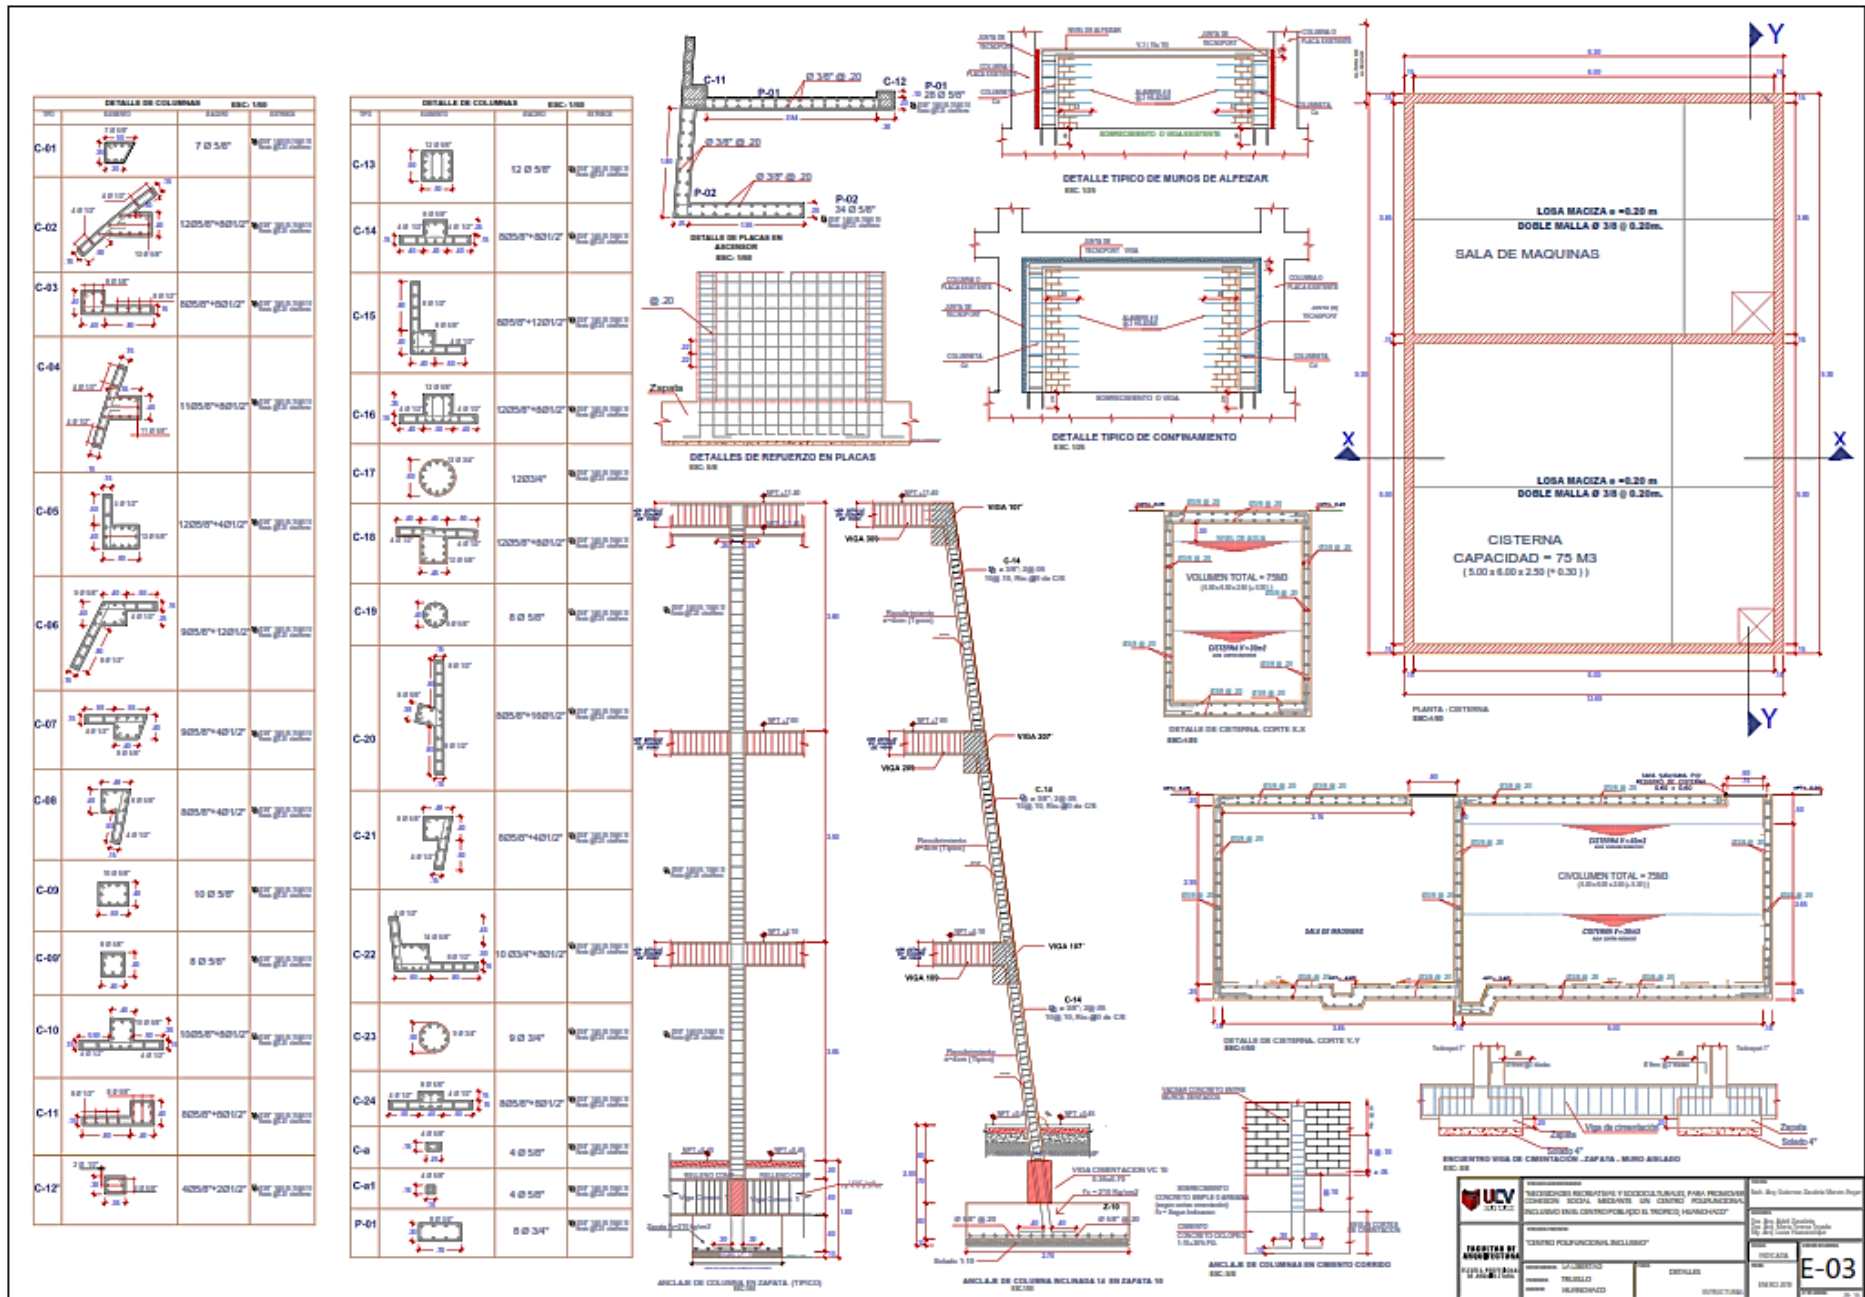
Plano detalles estructurales. Columnas, placas y Cisterna: E-03. Fuente: Propia (2018)
